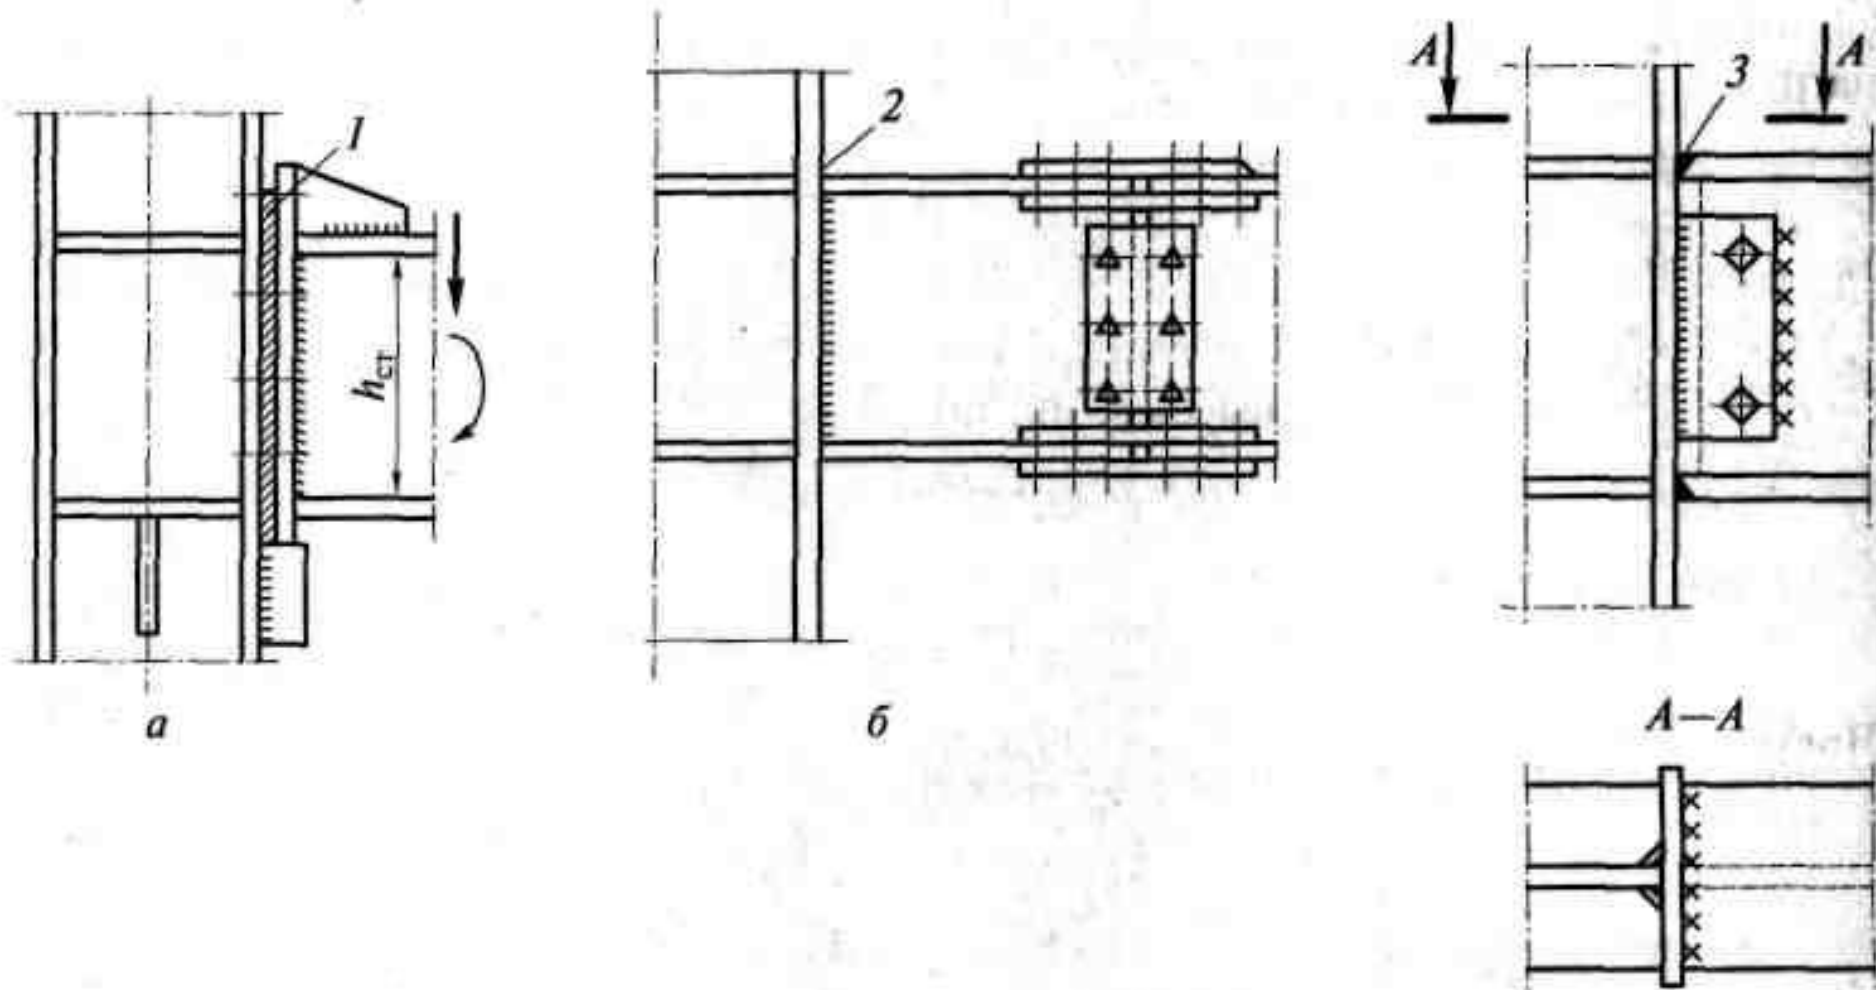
Жесткое прикрепление балки к колонне (схемы):
